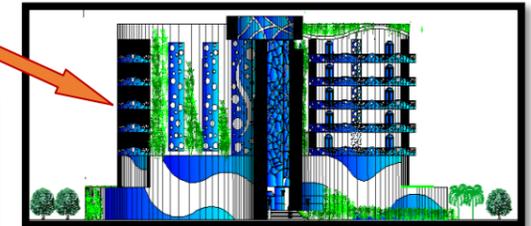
les brises soleil au niveau de la façade source : auteur
